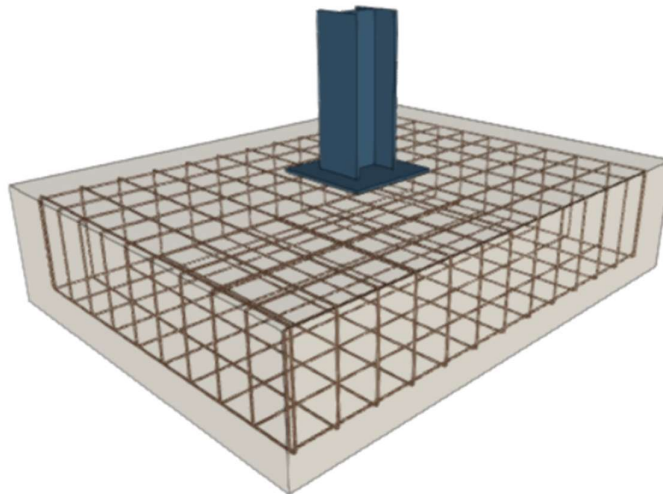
Zapata tipo pilares exteriores nave almacén/vestuarios.
